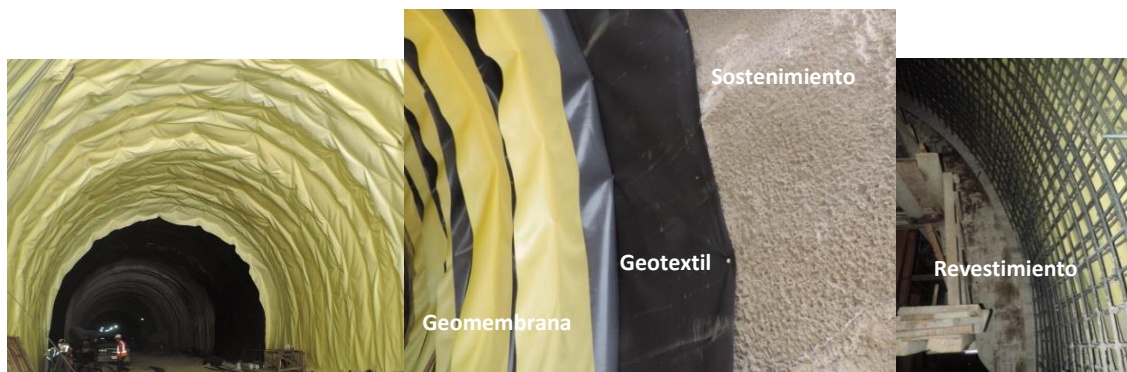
Sostenimiento, sistema de impermeabilización y revestimiento.
